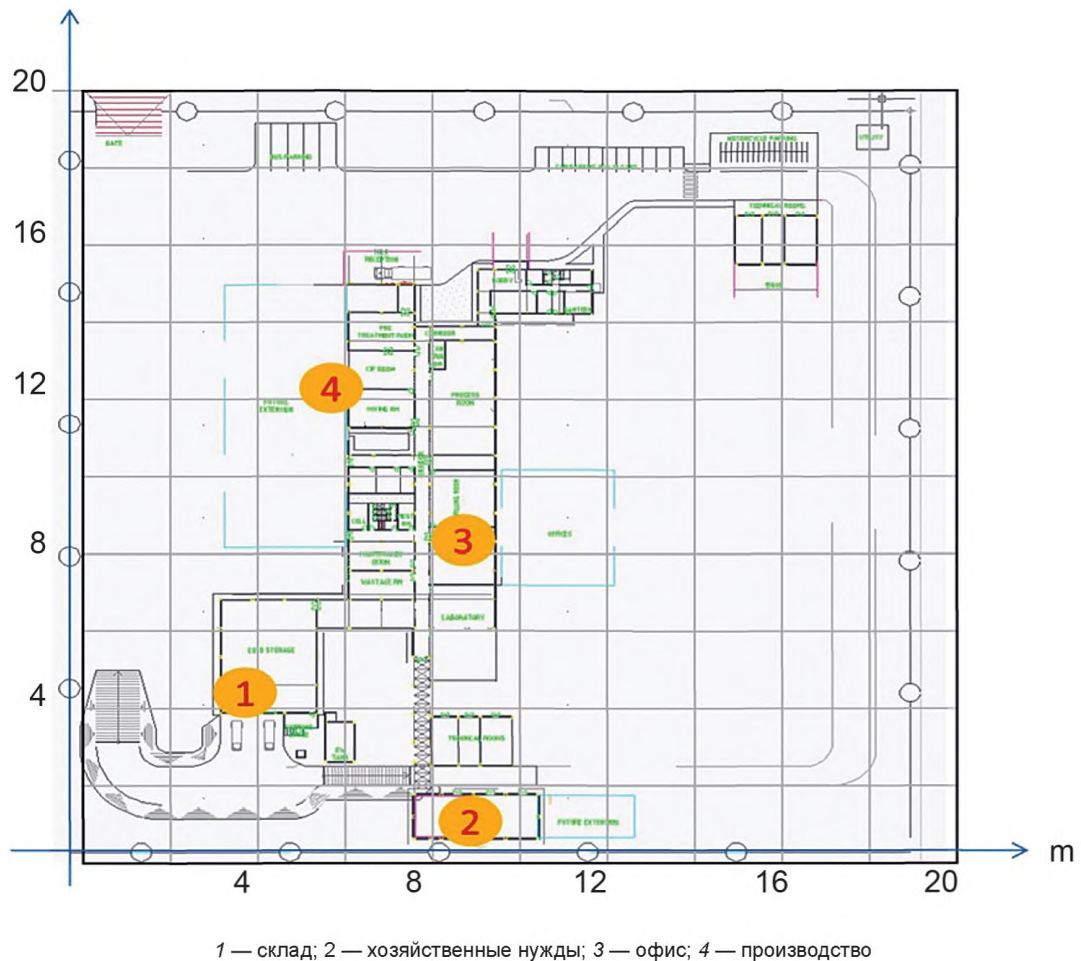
Пример 1: План здания завода с планом расположения нагрузок и расчетным центром нагрузок
